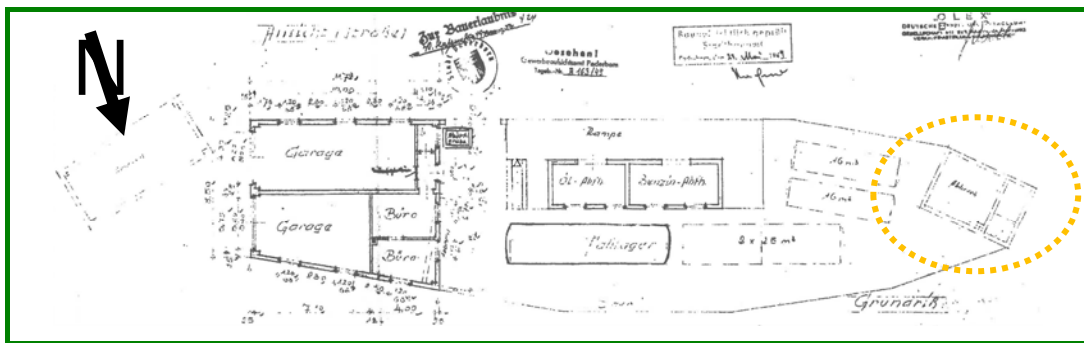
Lageplan aus 1949; Markierung: Rückbau Altgebäude
